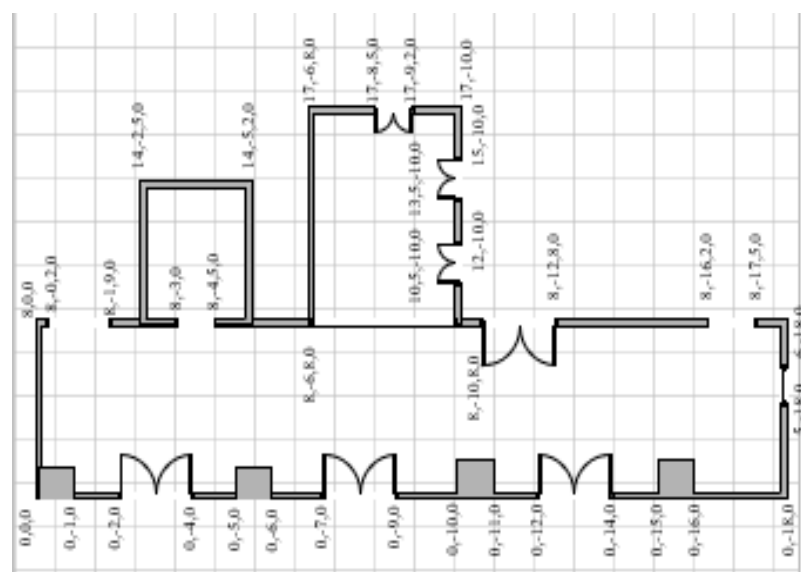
Tampilan Awal Floor Plan Project pada Visio 2019
